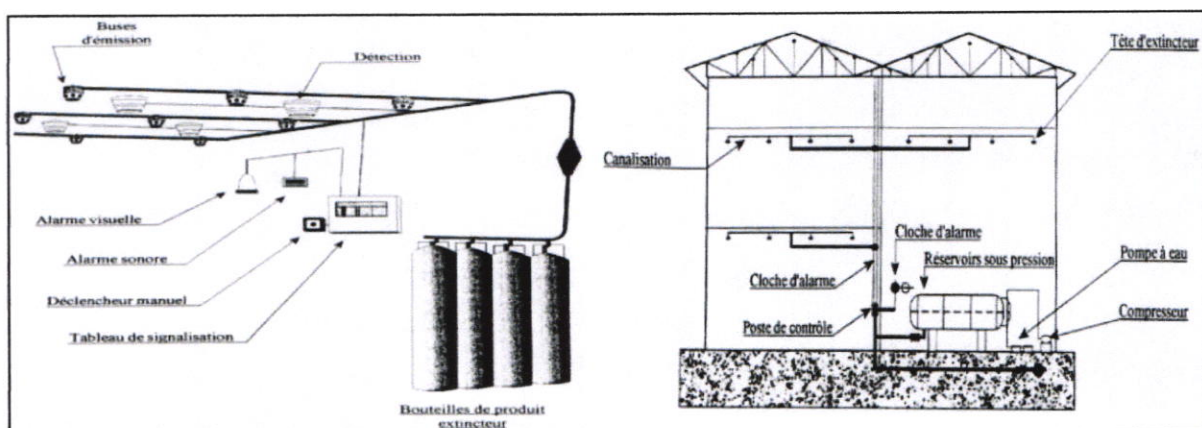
Schémas d'installation des sprinklers ; source : <http://entreprise.mma.fr>
